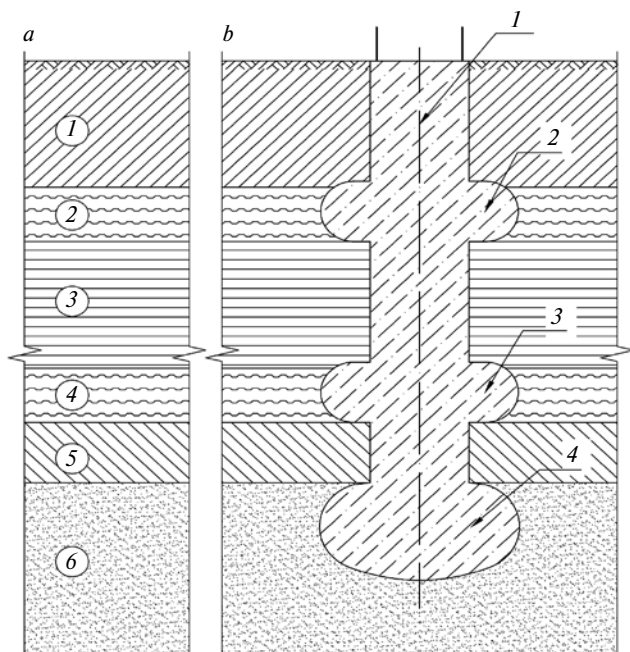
Врезка в инженерно-геологический разрез буровой грунтобетонной сваи с многоместными уширениями: а – разрез (1–6 – инженерно-геологические элементы (ИГЭ)); 2, 4 – слабые ИГЭ; б – устройство сваи: 1 – железобетонный ствол сваи; 2, 3, 4 – промежуточные уширения (подпятники)
